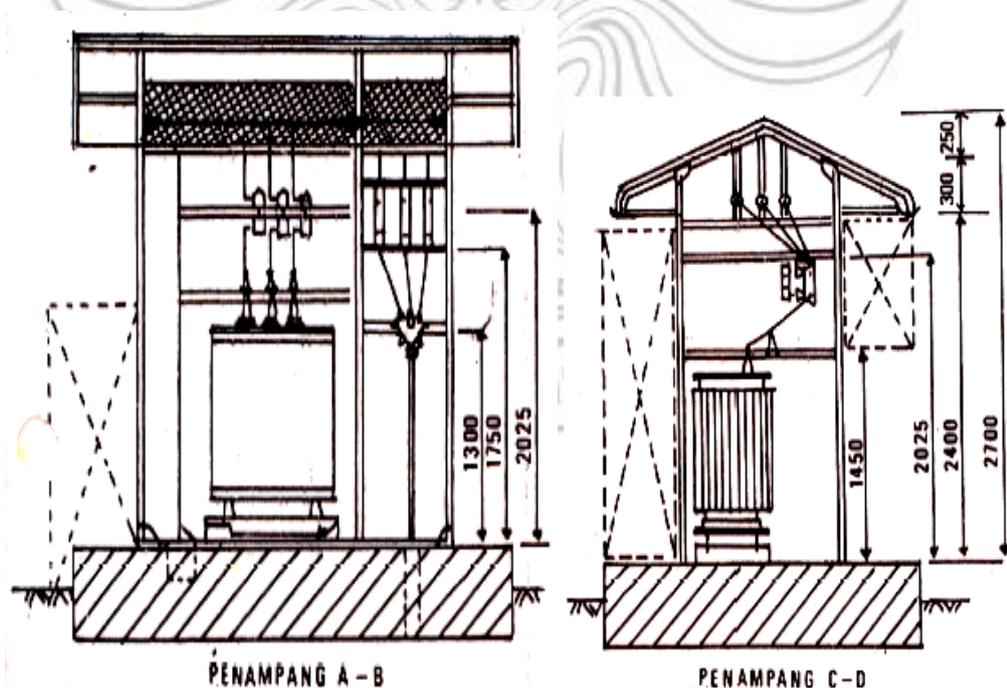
Tampak Samping Gardu Beton (Sumber :Standar Konstruksi PLN)
